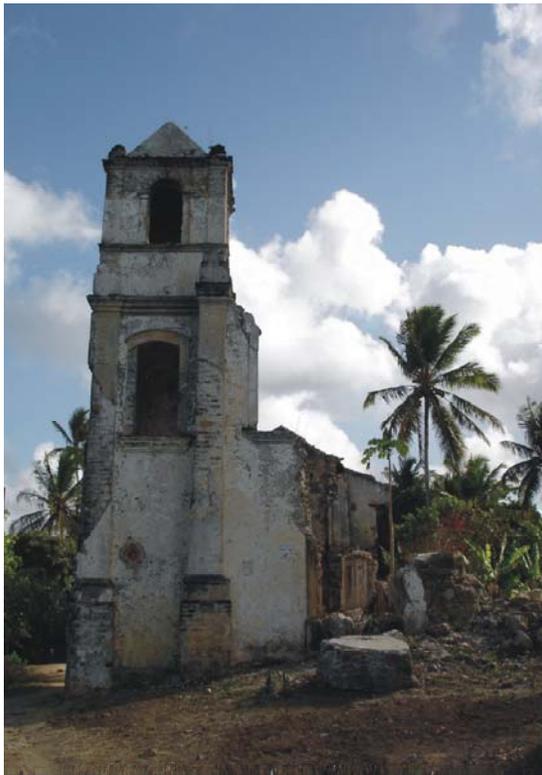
Fachada frontal. (Autoria: Leandro Surya).
